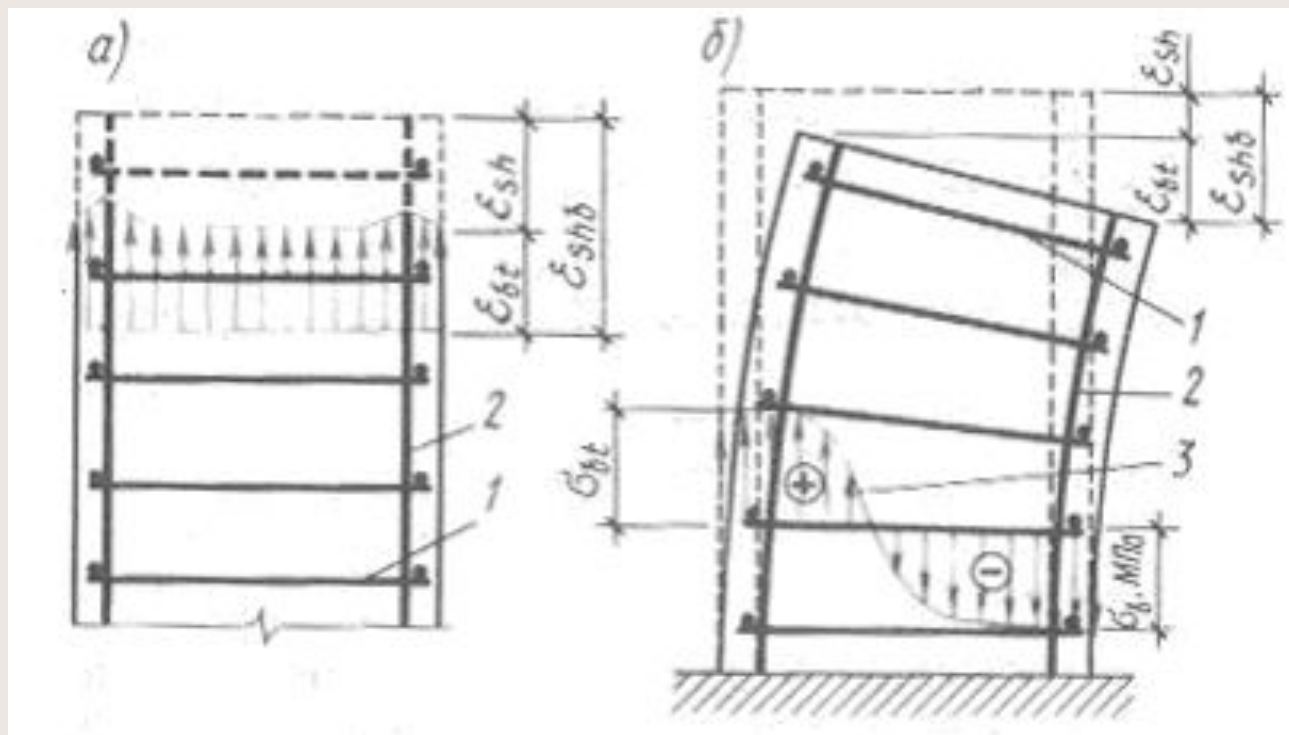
Схема деформации армированного элемента от усадки бетона
